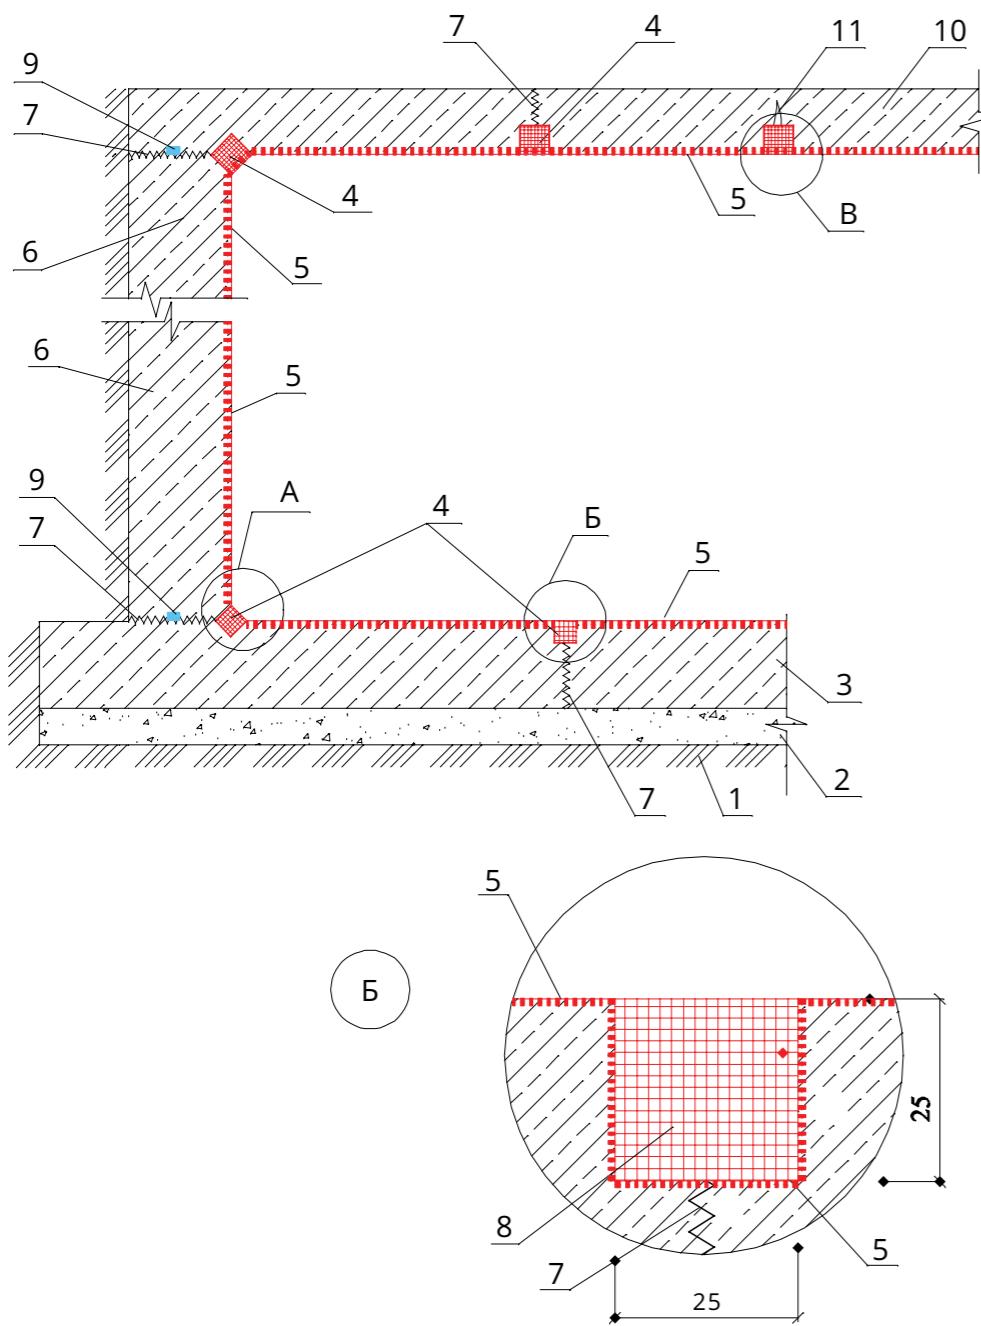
Узел 2. Гидроизоляция покрытия стены;
